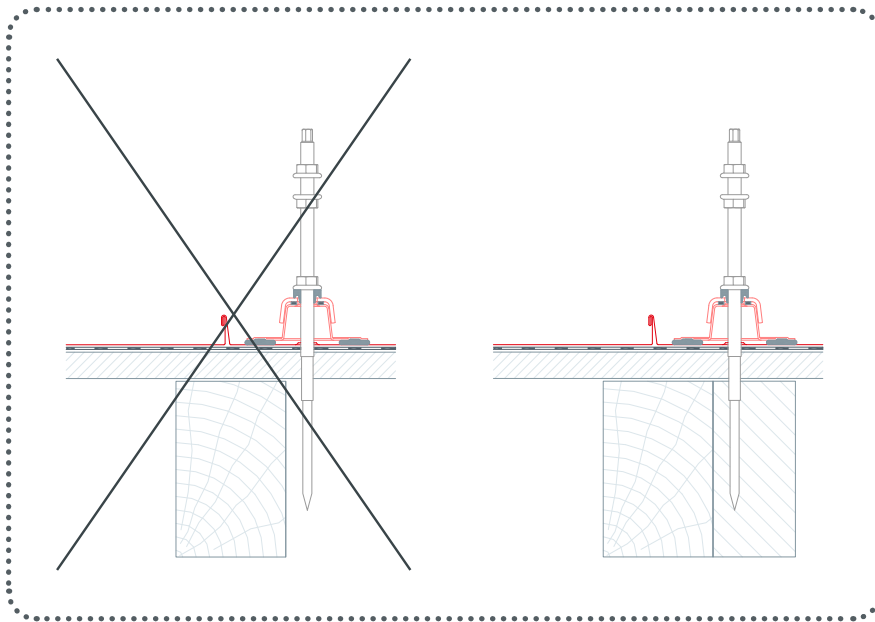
· Sondermaßnahme bei einschaliger Dachkonstruktion
